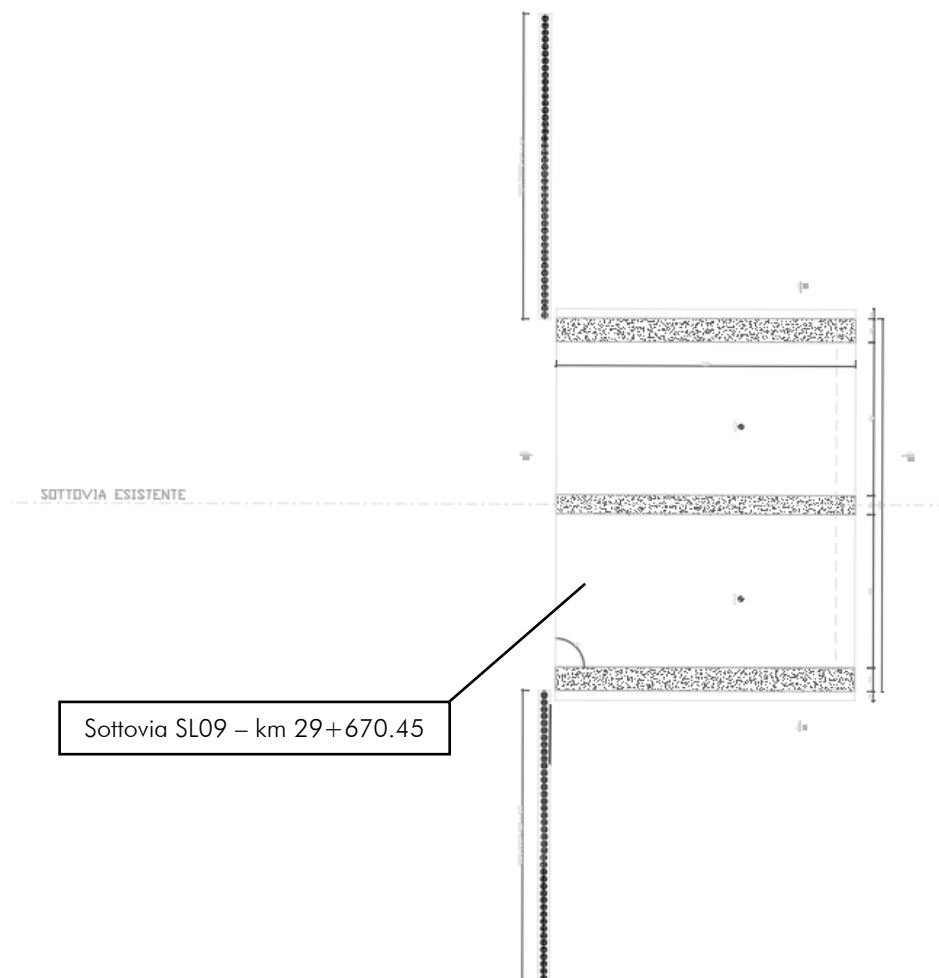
Stralcio planimetrico – Ubicazione sottovia SL09
